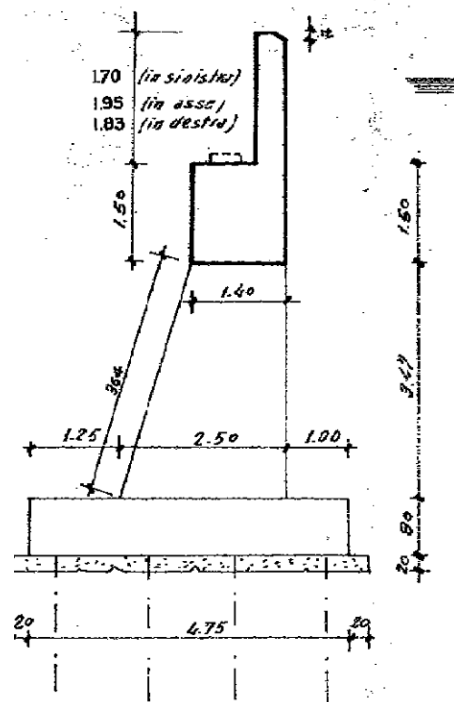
Sezione trasversale spalla esistente
